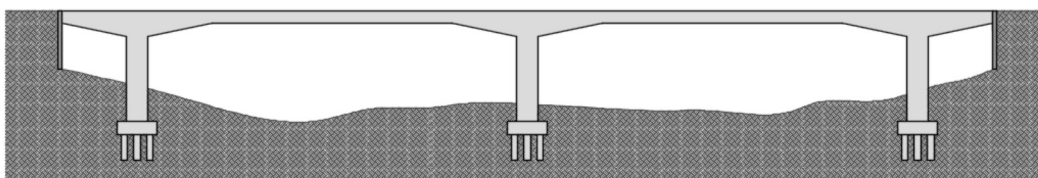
Exemplo de uma ponte com estrutura principal do tipo pórtico.
